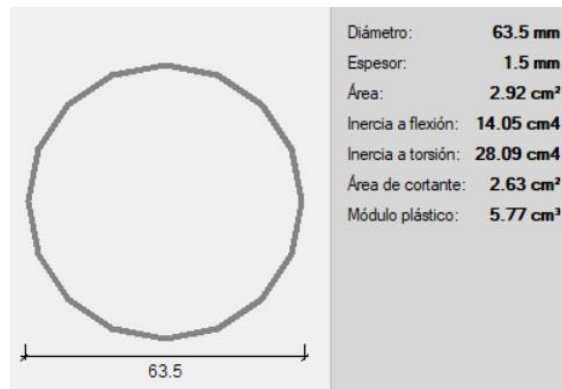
Dimensiones del tubo laminado O2+1/2x2.29
